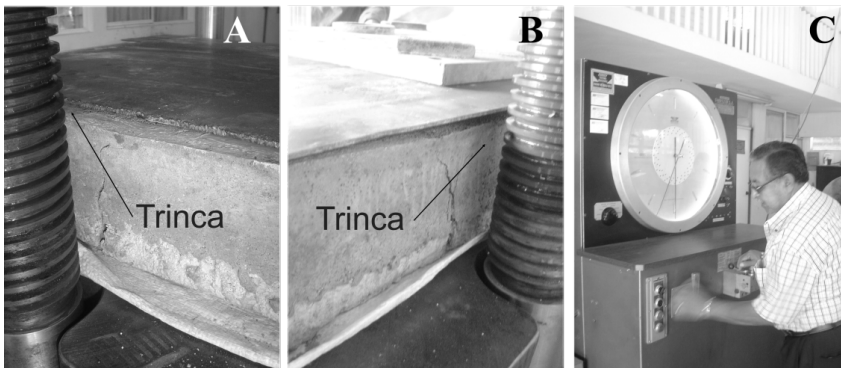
En las fotos A y B, se presenta el elemento después de la apertura de las primeras fisuras que surgen por la carga realizada.
